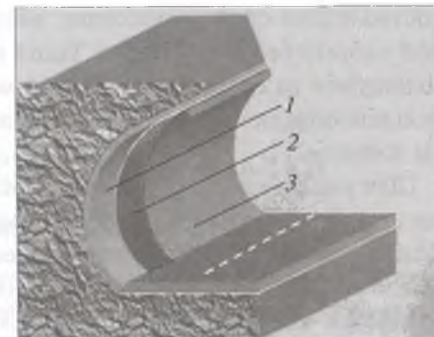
Поперечное сечение тоннеля с гидроизоляцией, нанесенной методом набрызга:
